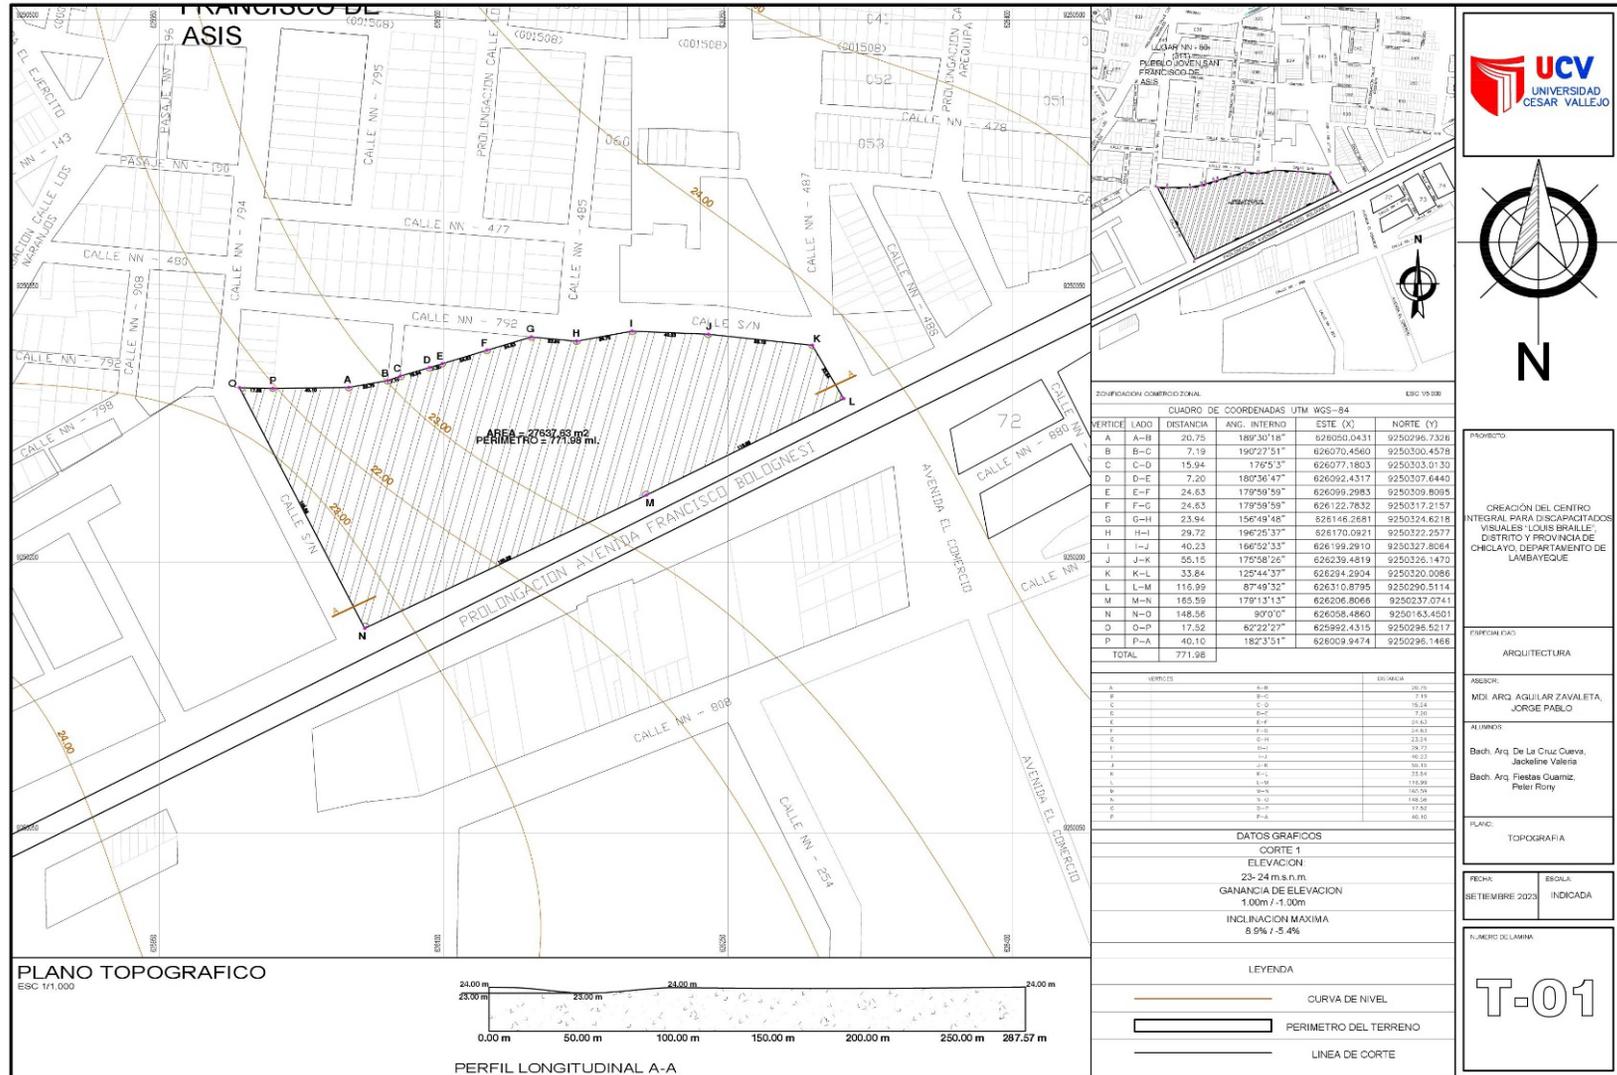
Plano de Ubicación. Fuente: Elaboración propia
